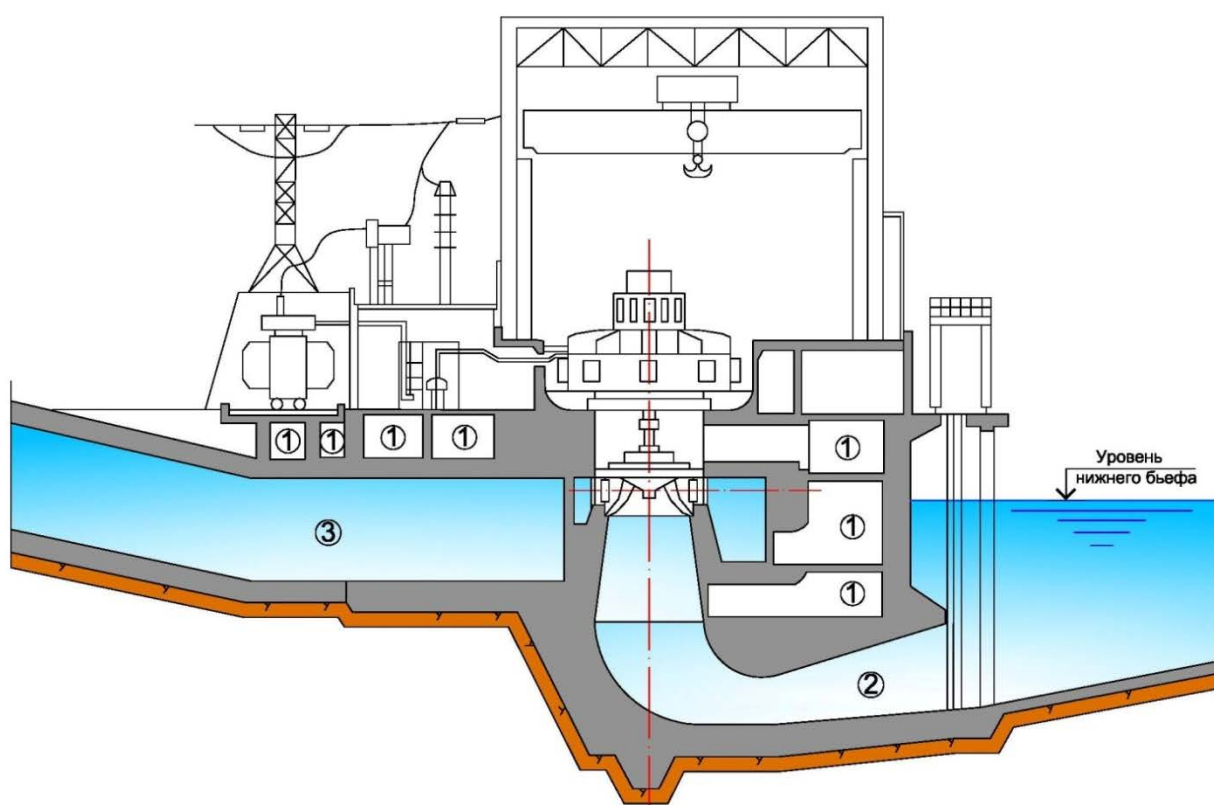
Поперечные разрез по зданиям малых ГЭС:
